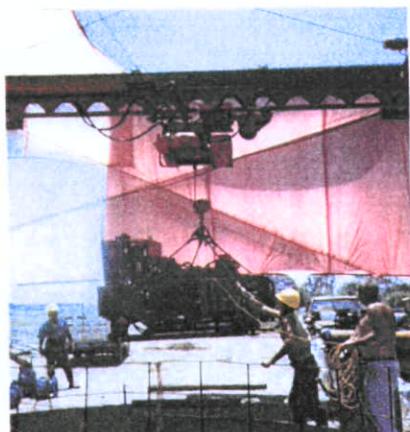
Grúa Viajera para bajar equipo de hincado horizontal
